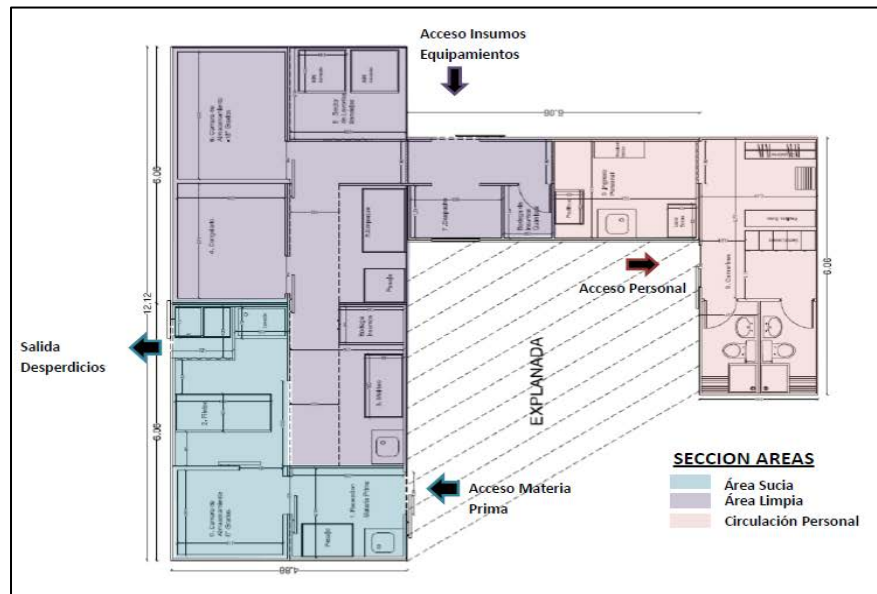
Plano de secciones de áreas sucias y limpias en el diseño de planta de proceso congelado.
